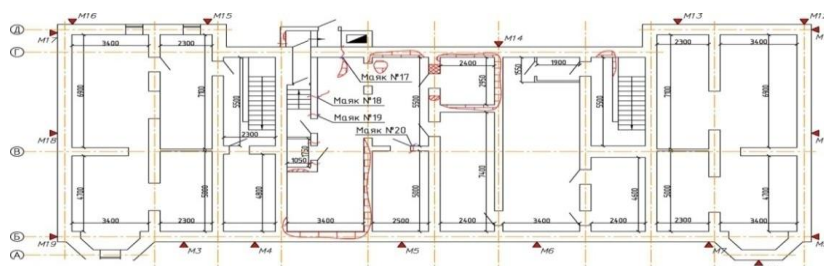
План типового этажа пятиэтажного жилого дома со схемой установки осадочных марок 1-25
